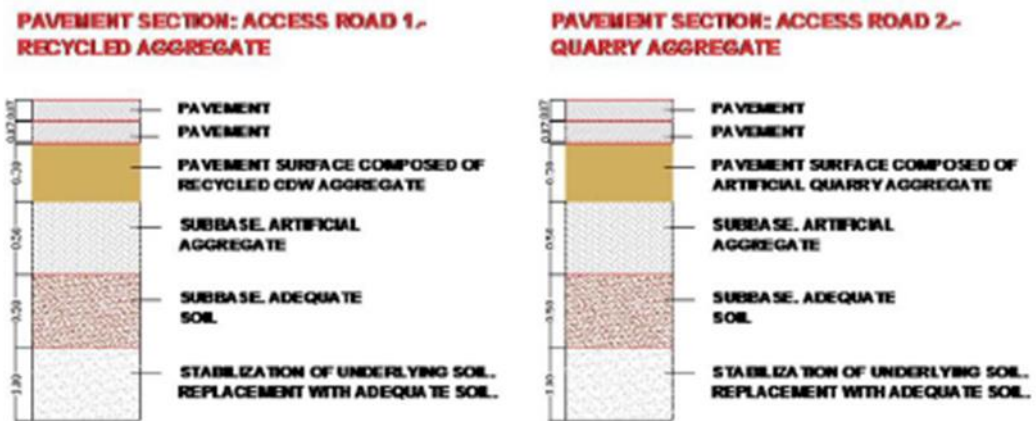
Sección hecha de RCD reciclado y pavimento hecho de agregado de cantera.
